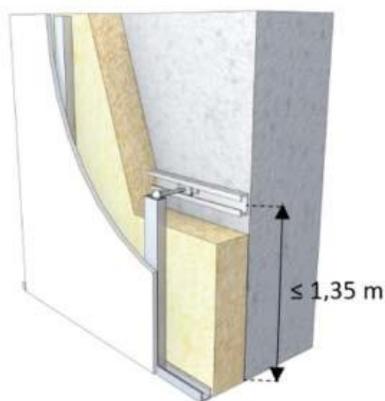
DETAIL AU DROIT D'UN APPUI INTERMEDIAIRE
